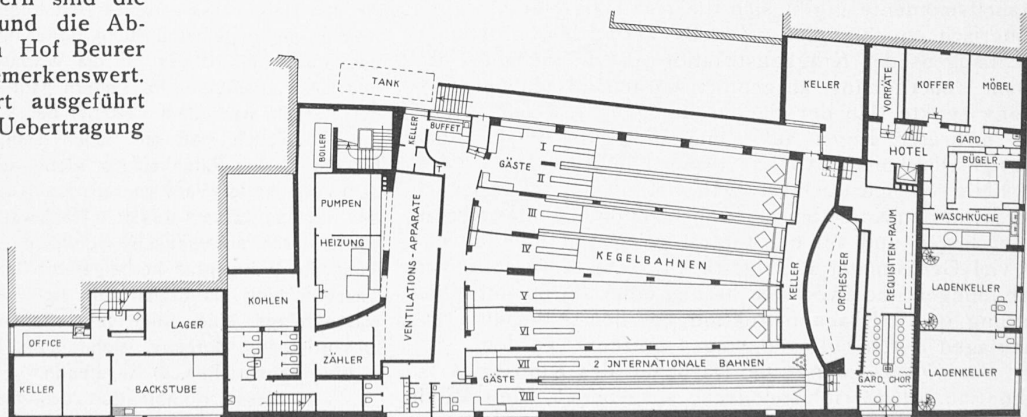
Kellergrundriss mit den Kegelbahnen. — Masstab 1 : 500.
